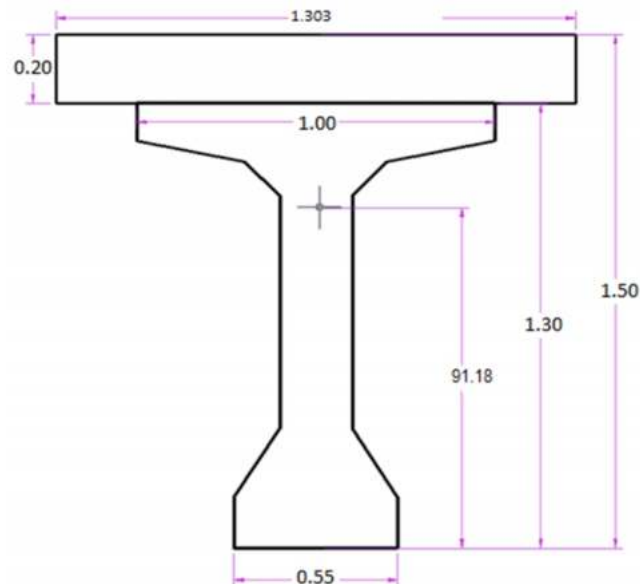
les dimensions de la section de la poutre de rive+l'hourdis
